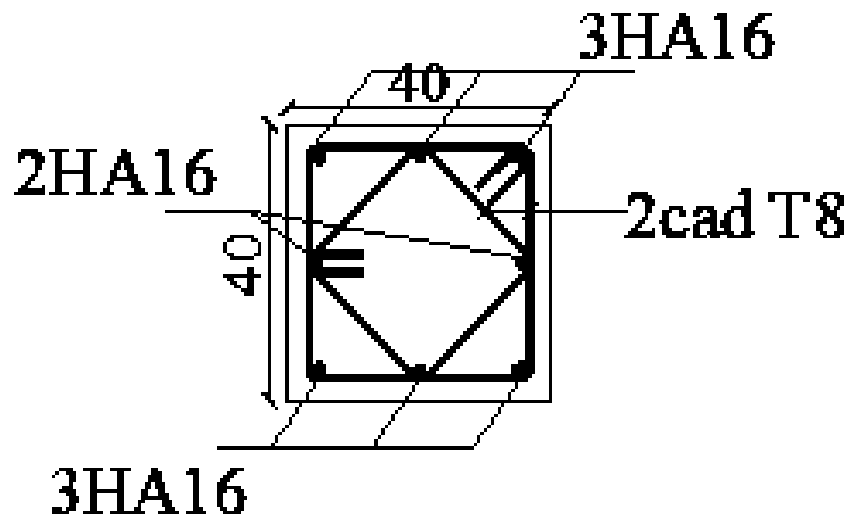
Ferrailage des poteaux 40 x 40
